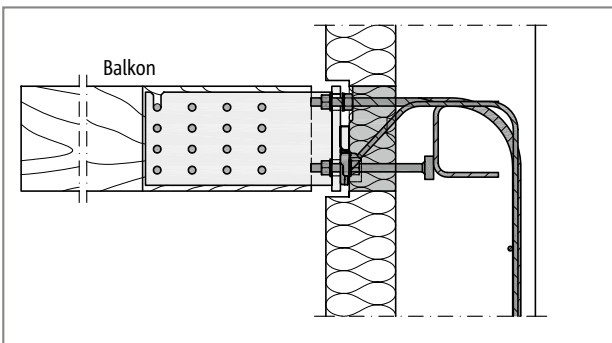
Schöck Isokorb® T Typ SKP-WU mit Stahlschwert: Sonderkonstruktion; erforderlich bei Anschluss an eine Stahlbetonwand
